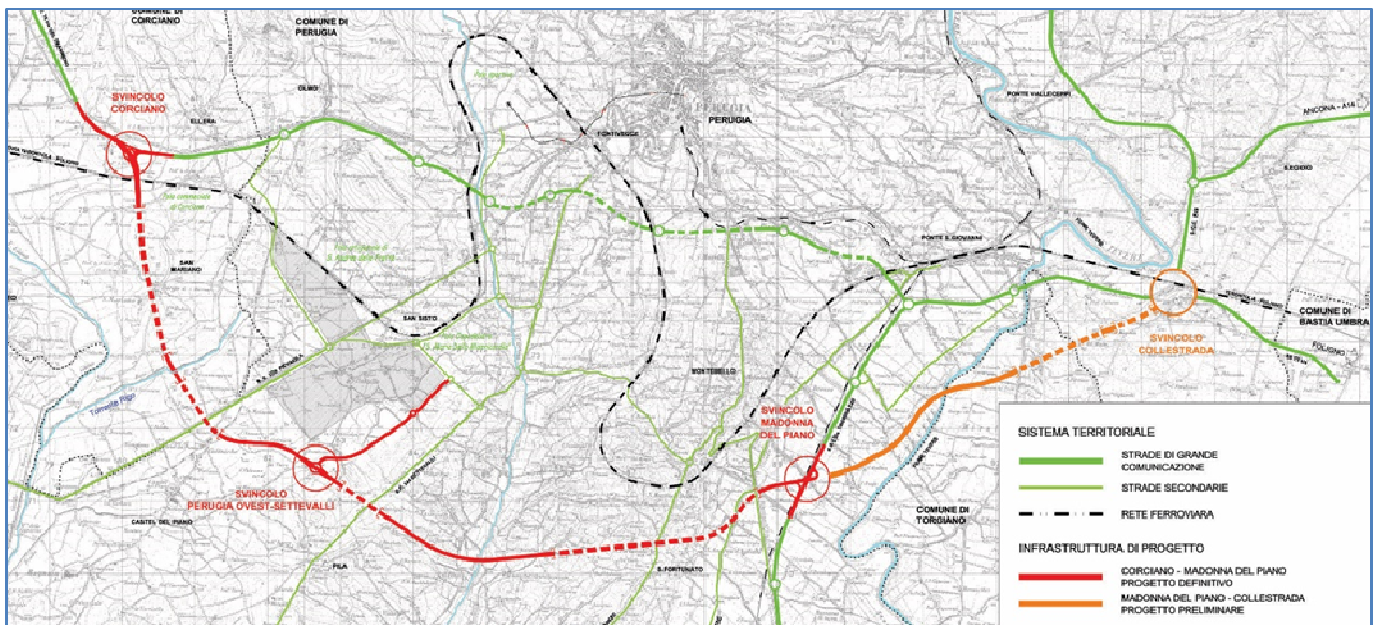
Progetto Preliminare: planimetria generale con individuazione delle tratte del Nodo di Perugia
